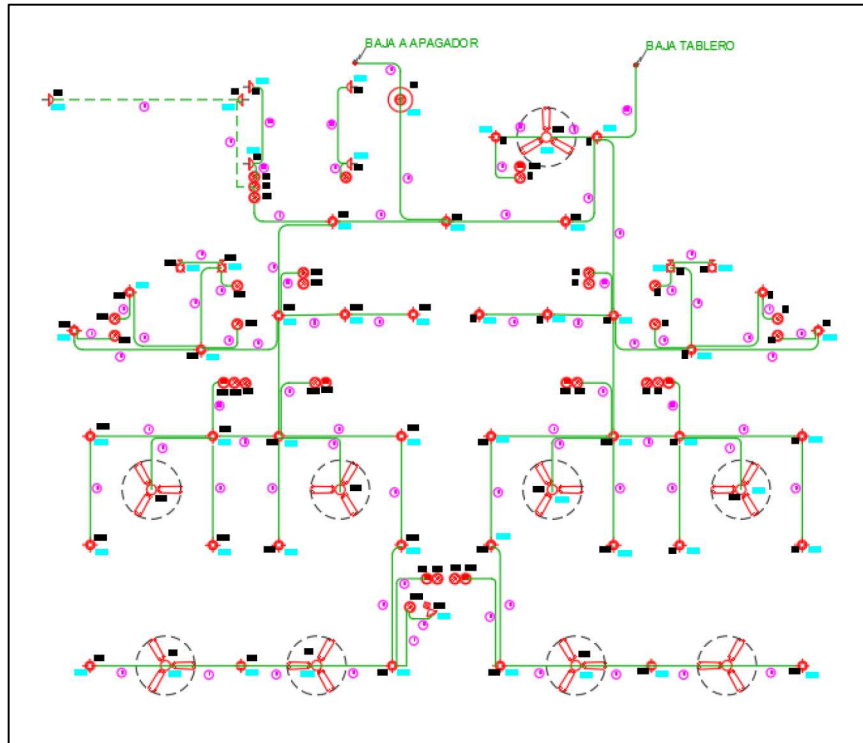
Plano de distribución eléctrico planta primer nivel.
